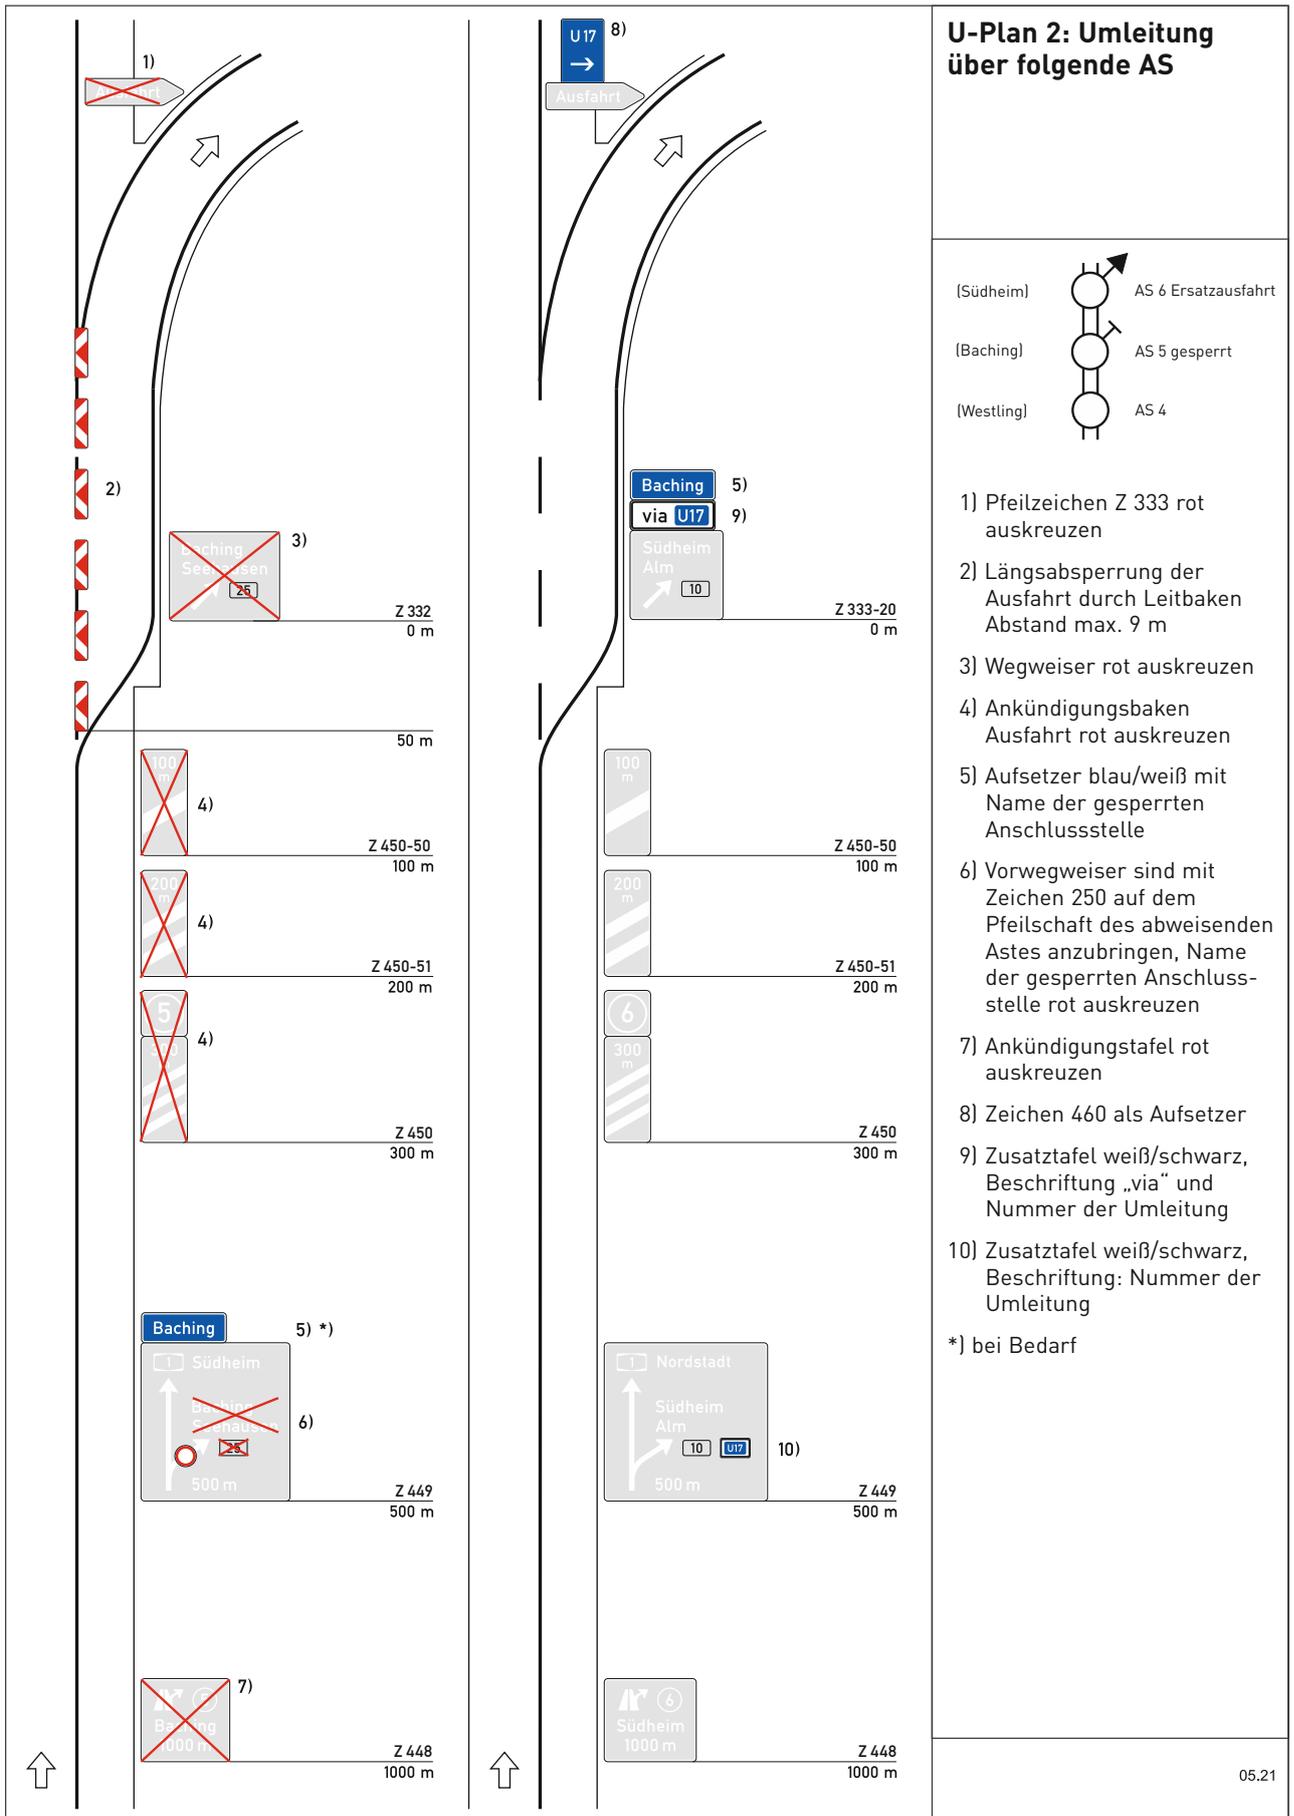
Umleitungsplan 2: Umleitung über nachfolgende Anschlussstelle
